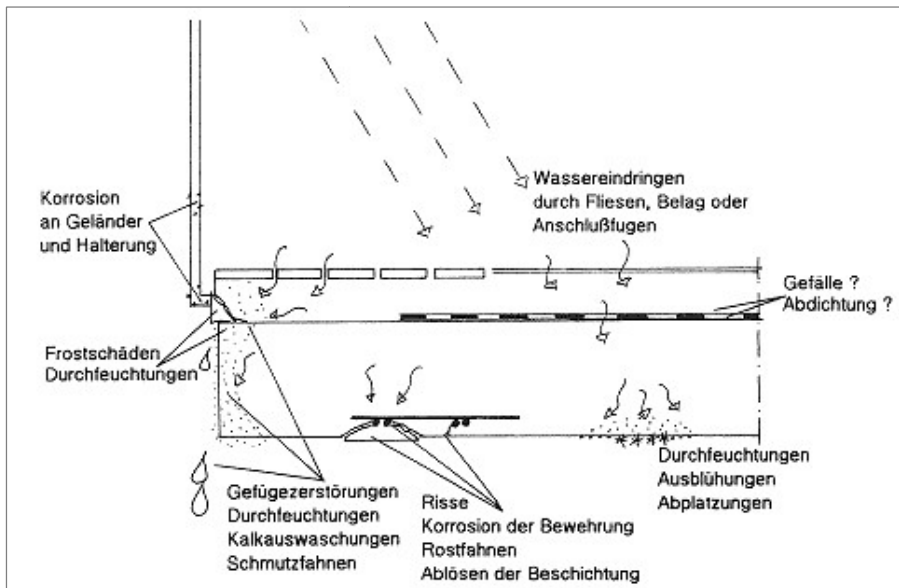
Balkenschäden infolge nicht funktionstüchtiger Entwässerung²¹⁸
